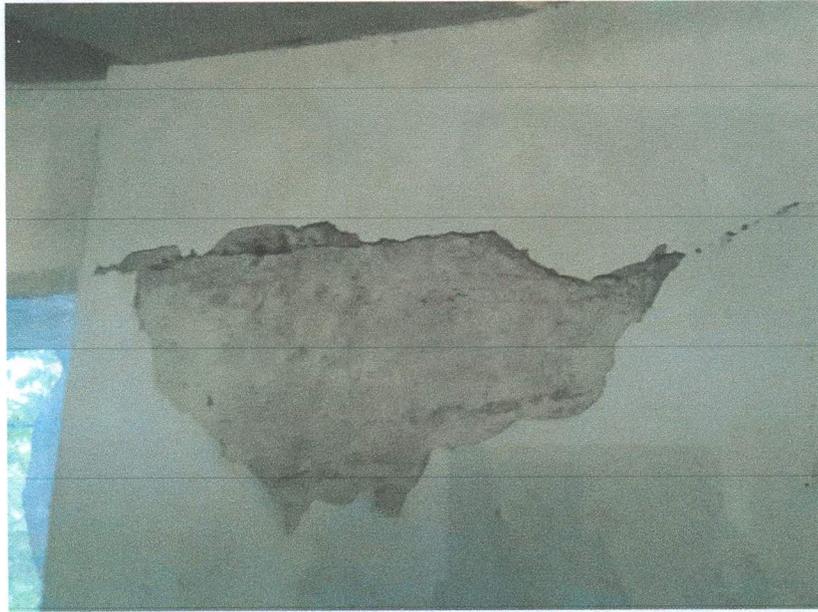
En esta fotografía se observan grietas horizontales sobre un muro de concreto que se localiza en el 1er. piso del estacionamiento en la parte sur del predio, formando un anillo entorno al muro de concreto, toda vez que no es posible verificar la profundidad de la grieta, se requiere realizar un diagnóstico, a través de radiografías, de esta manera dar un diagnóstico completo y sobre esto solicitar se realicen algún probable reforzamiento.
